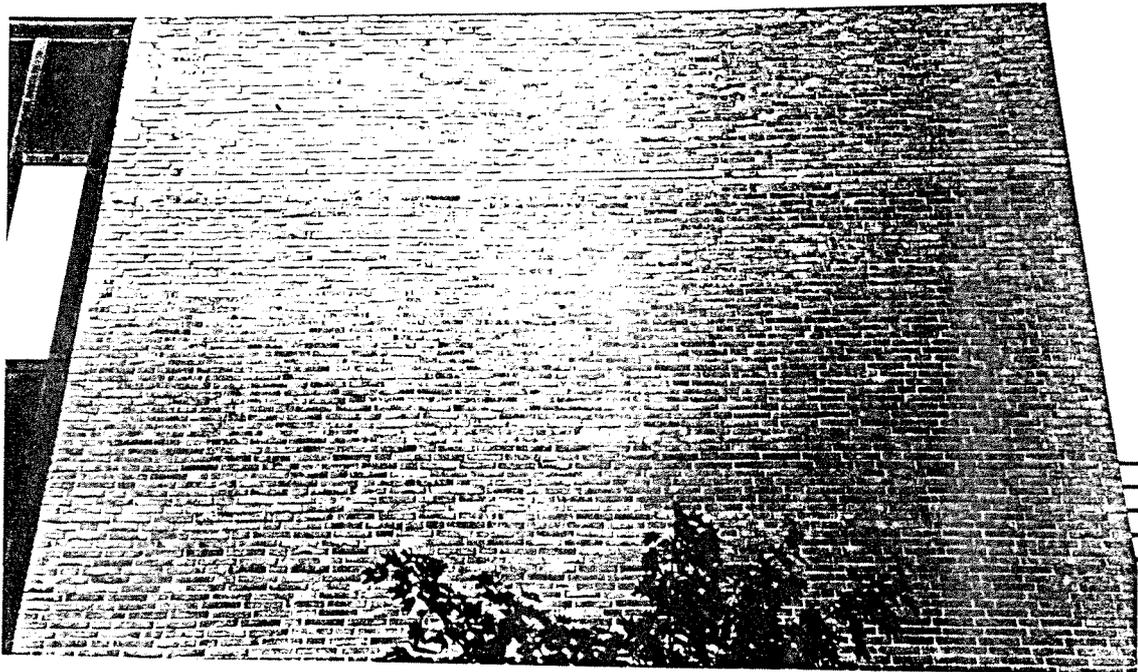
Giebelbereich Gebäude A, Süd-Südostfassade
